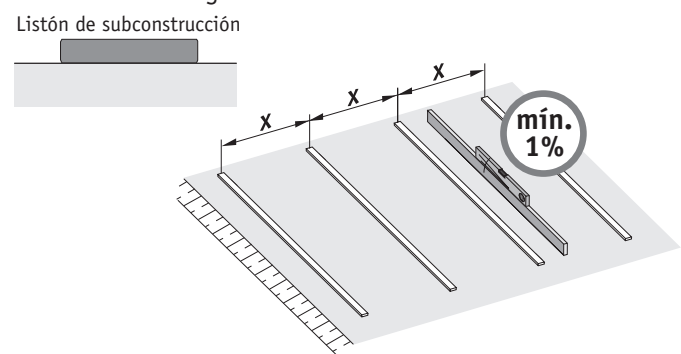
Colocación con listón de subconstrucción sobre suelos de hormigón
